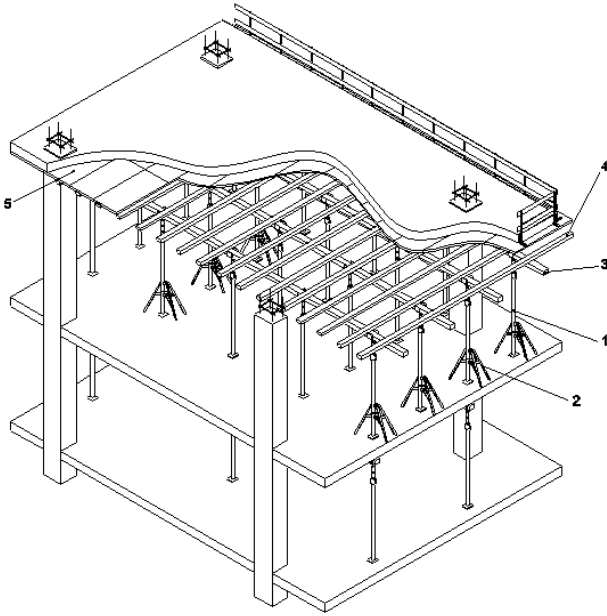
Конструкция опалубки бетонирования перекрытия на основе телескопических стоек:
